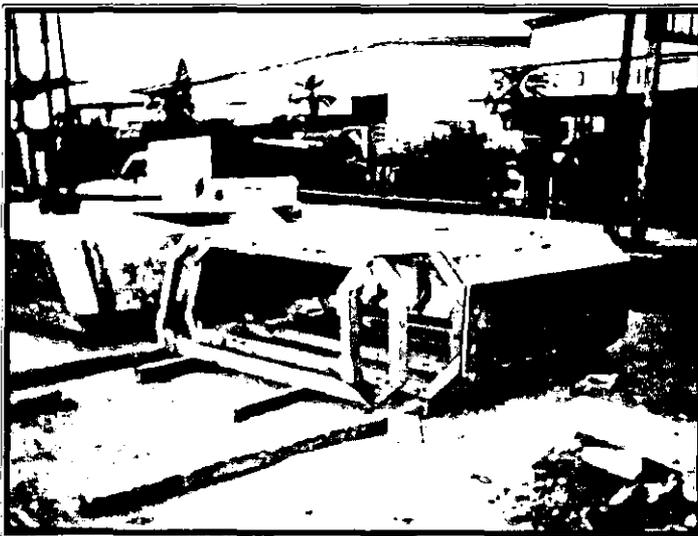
Fabricación de la cimbra circular de madera para las columnas de las pilas 3 del Cuerpo A y 6 del Cuerpo B.
